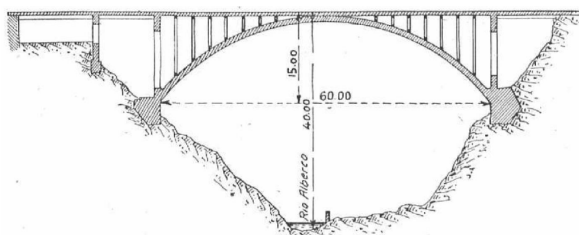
Alzado extraído de la revista “La Construcción Moderna”, noviembre de 1924
